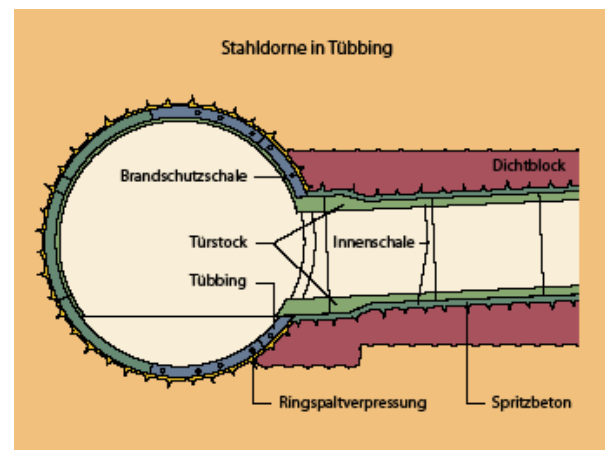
Systematische Darstellung des Anschlusses Rettungsstollen an den Haupttunnel
